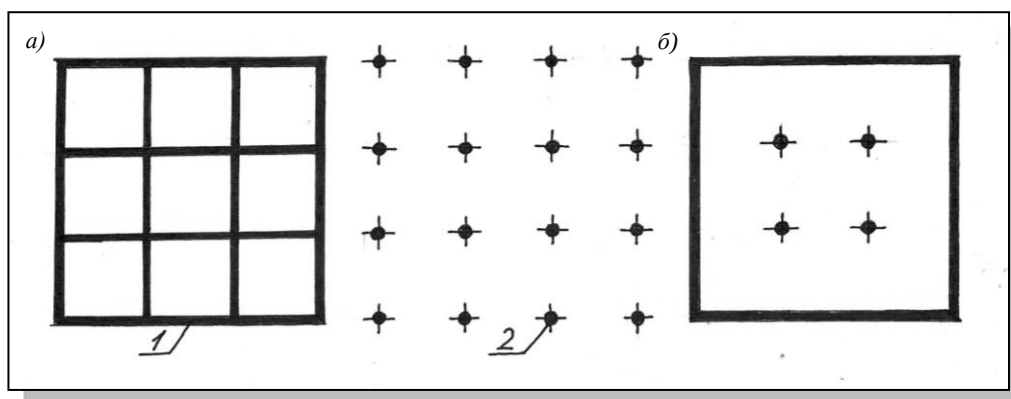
Конструктивные схемы зданий: а – бескаркасная с несущими стенами; б – каркасная, с неполным каркасом: 1 – стены; 2 – колонны
